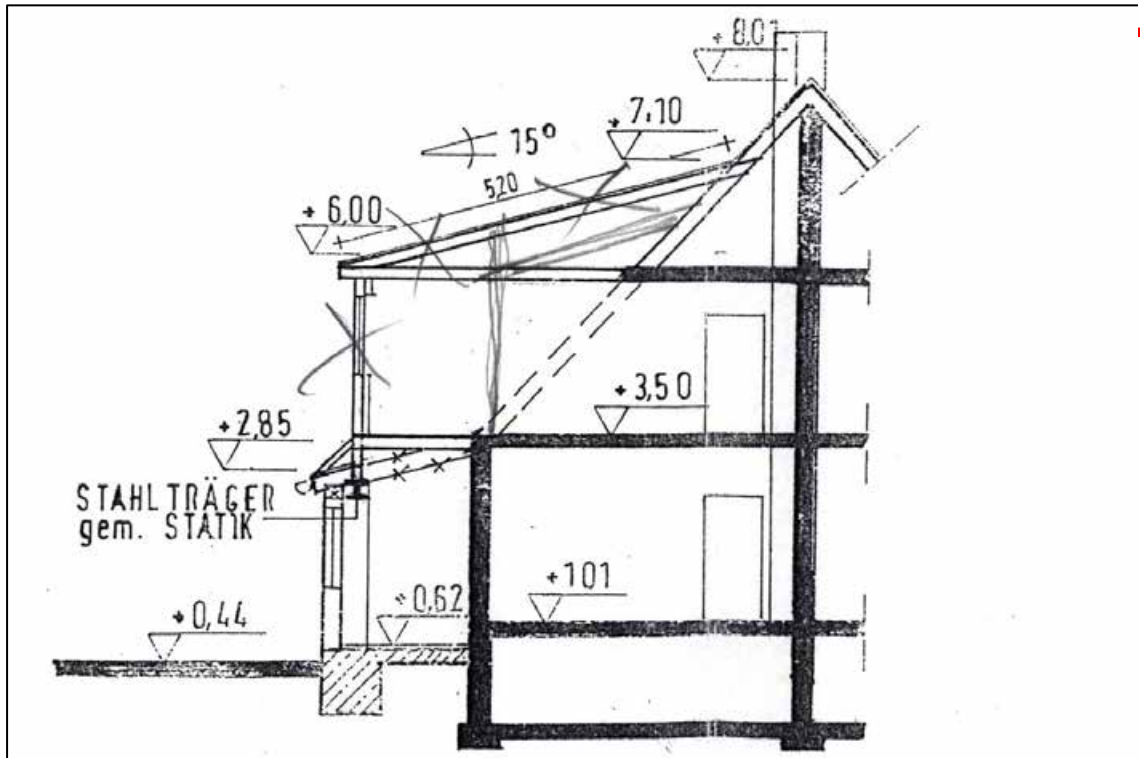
Schnitt durch die Einfamilien-Doppelhaushälfte ohne Maßstab. Der geplante Dachgeschossausbau wurde in reduzierter Form durchgeführt (siehe Schnitt). aus den Bauakten der Stadt Hamm © Stadt Hamm
